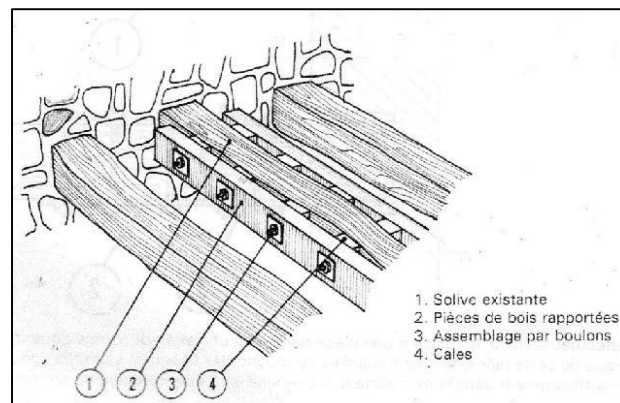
Renforcement d'une solive sur toute sa longueur
